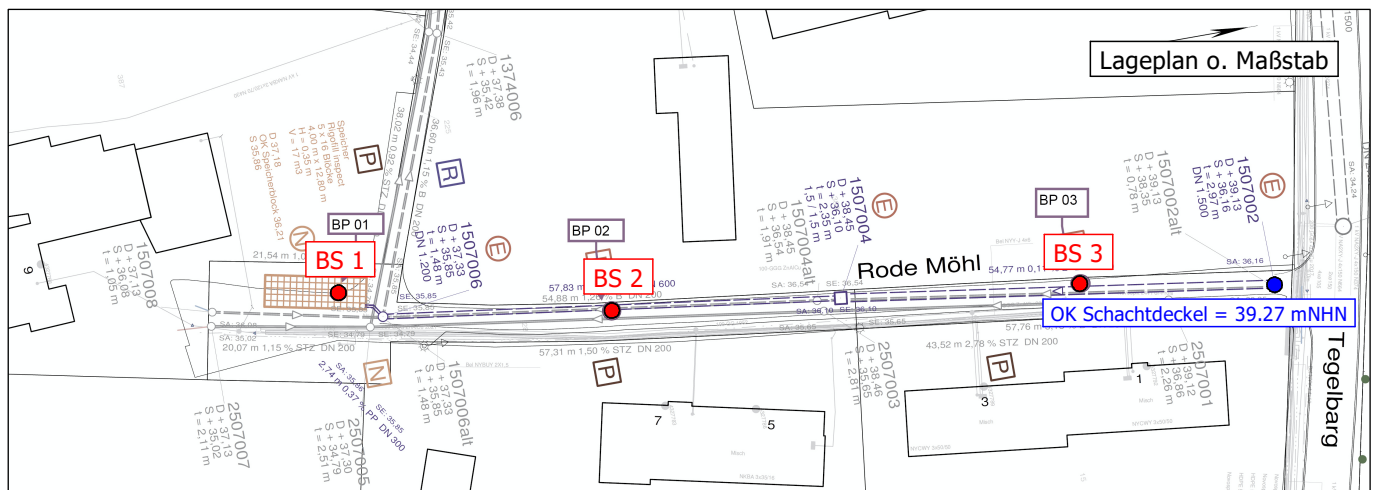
Lageplan RWTG 09 s. Anl. 1.2 (o. M.)
